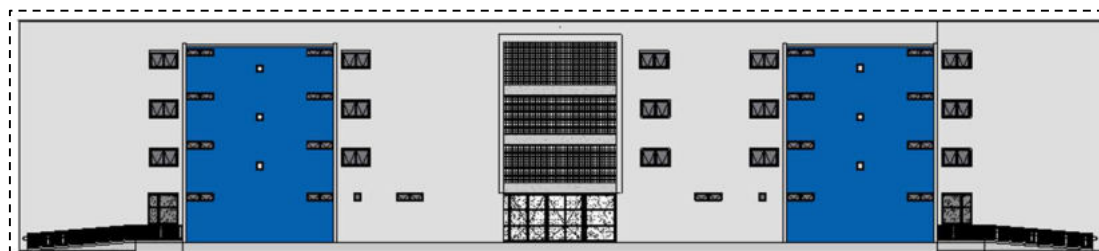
Fachada Norte com elementos vazados em concreto. Fonte: o autor.
